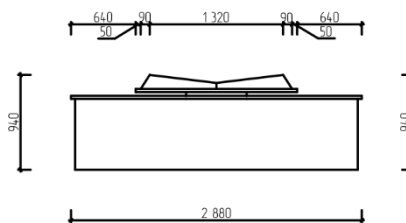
Чертёж фонтана. Вид прямо
